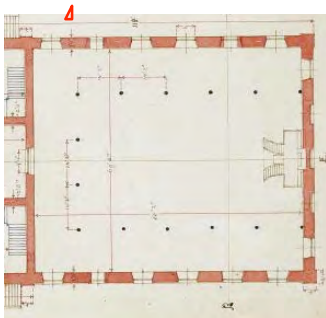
Grundriss Ausschnitt mit einer eingezeichneten Tür links in der oberen Außenwand
